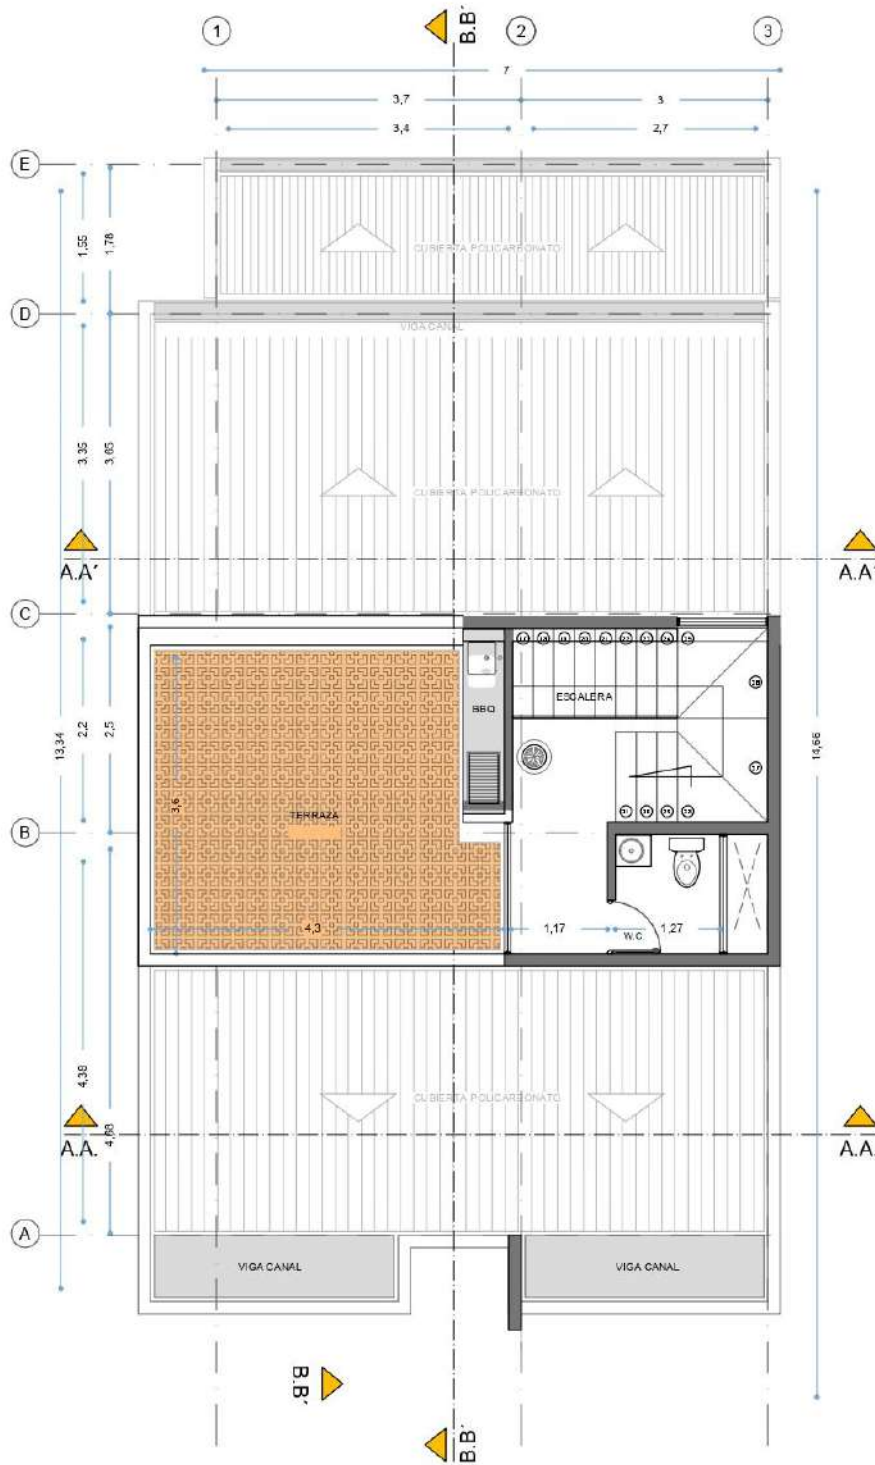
Planta de cubiertas casa San Sebastián; Fuente: Constructora Pérez
